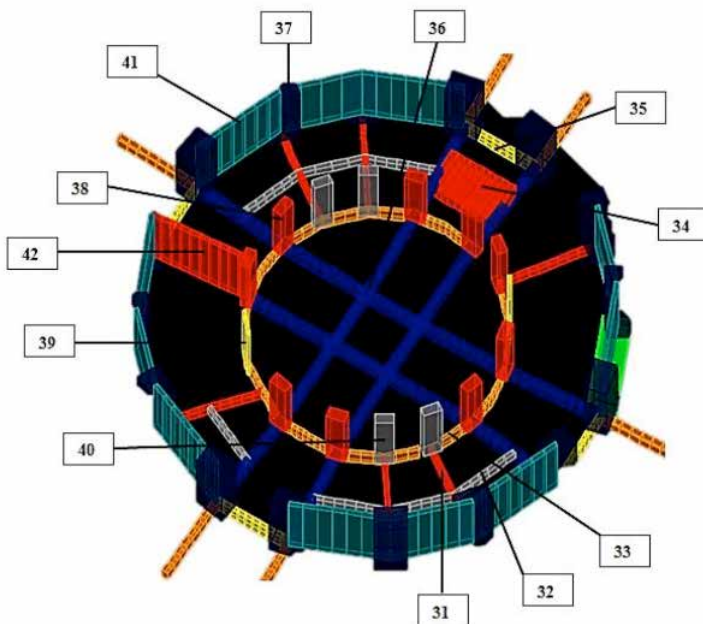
Elementos estruturais do núcleo rígido modelados, bloco A.
